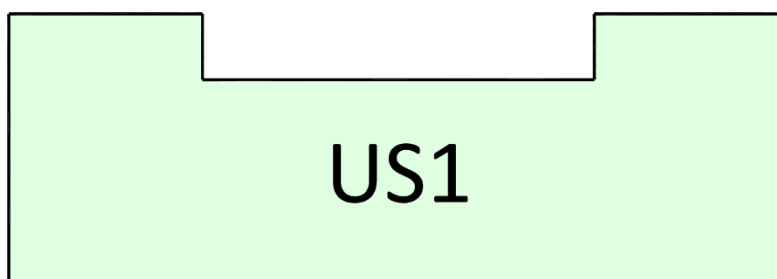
Suddivisione dell'edificio in Unità Strutturali.
